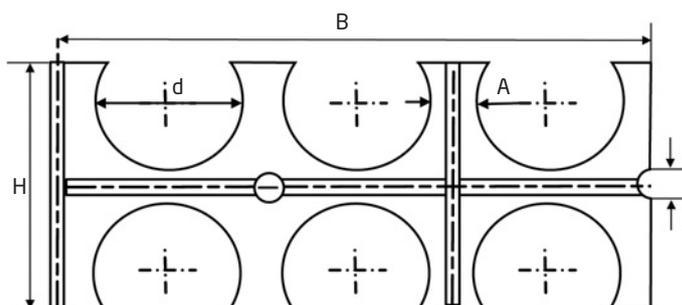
Dimensionamentos das espaçadeiras para colocação de Tubos PVC
